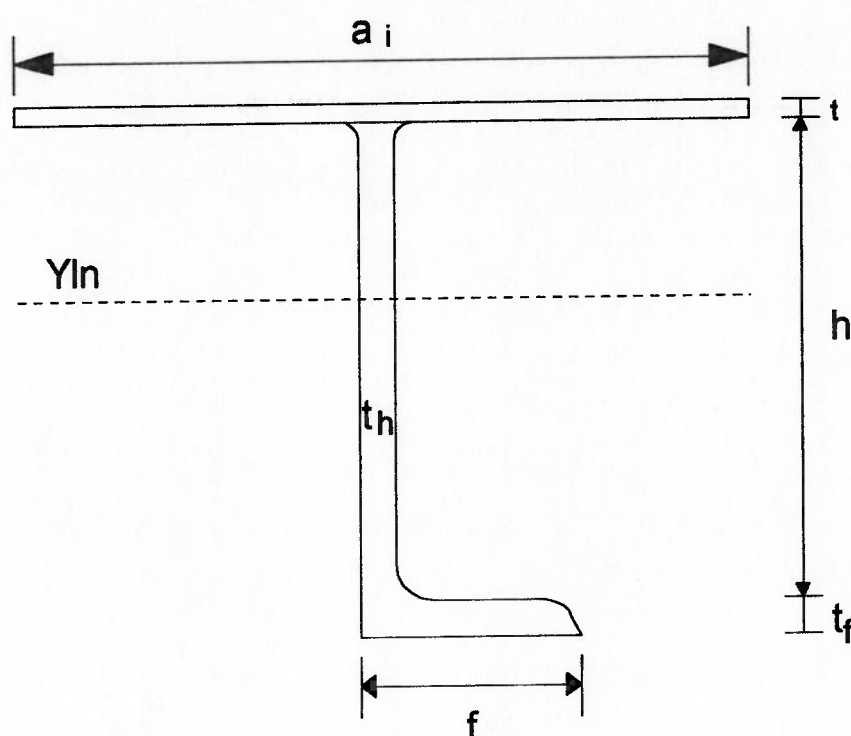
Dimensionamento do Perfil com chapa colaborante
